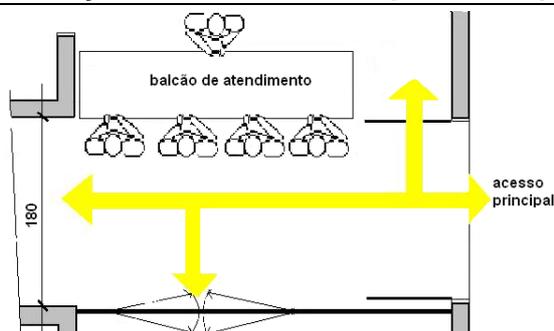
Planta baixa da área do balcão de atendimento (sem escala)
